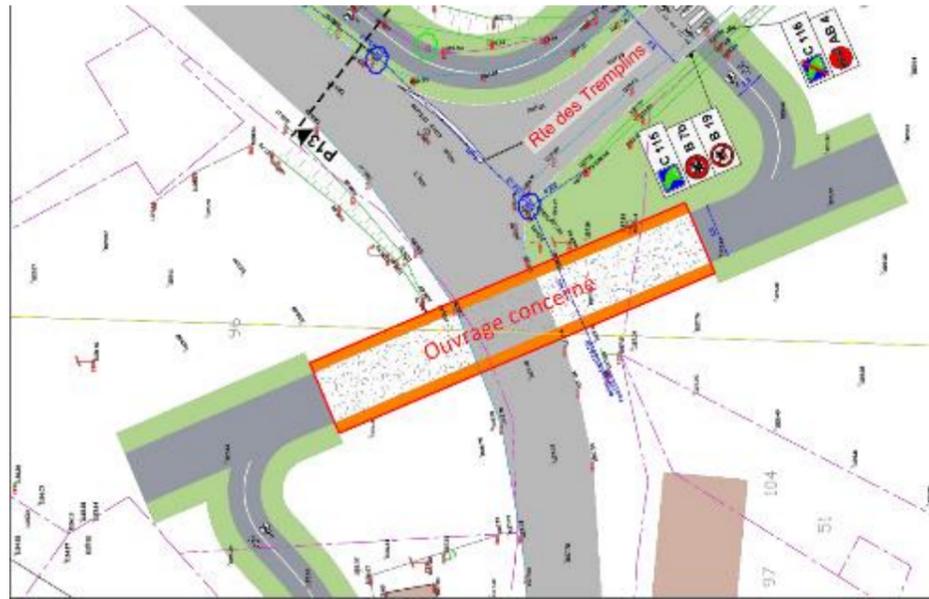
Section 2-6 Implantation de l'ouvrage génie civil - Route des Tremplins
